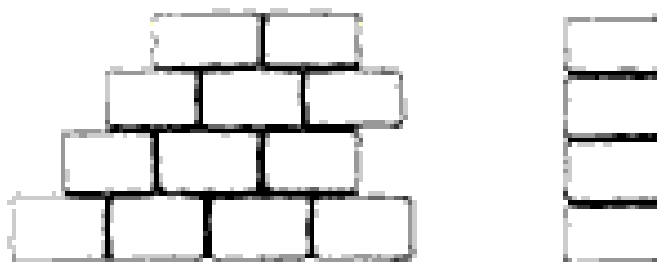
Esquema construtivo de parede de pedra com aparelhamento -Perpianho
